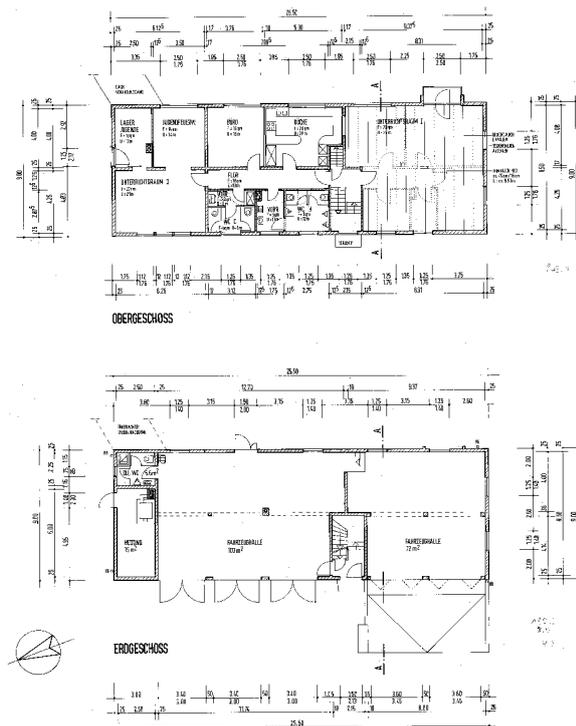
Grundrisse Erdgeschoss und Obergeschoss
